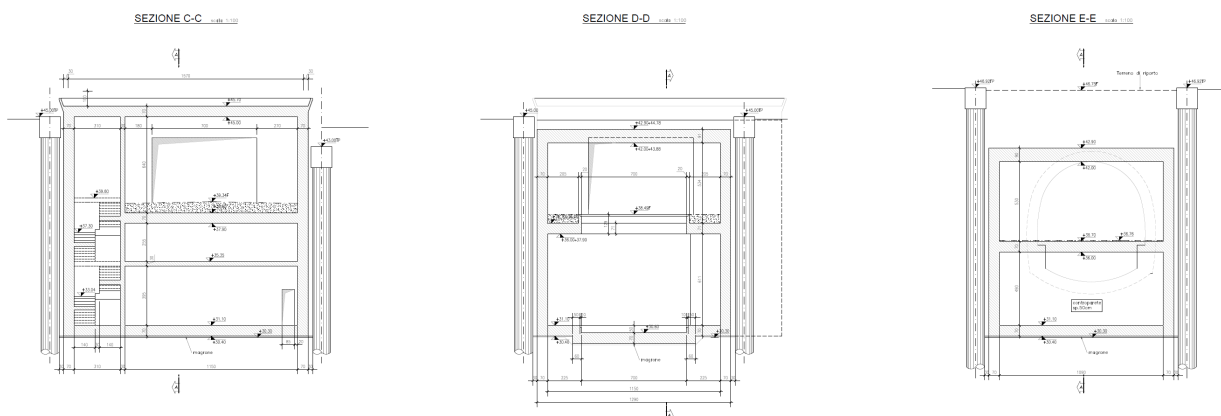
Rampa di accesso alla galleria di sfollamento, sezioni
